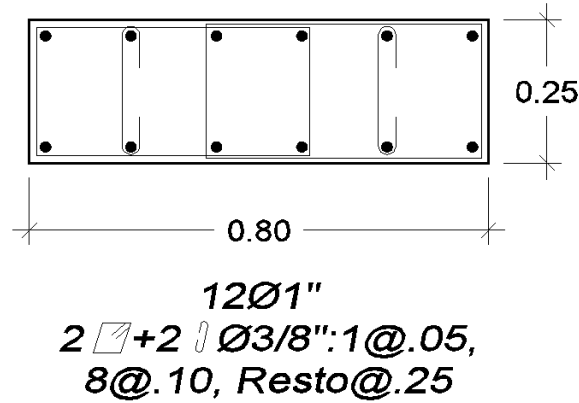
Distribución de refuerzo en sección de columna C-03
